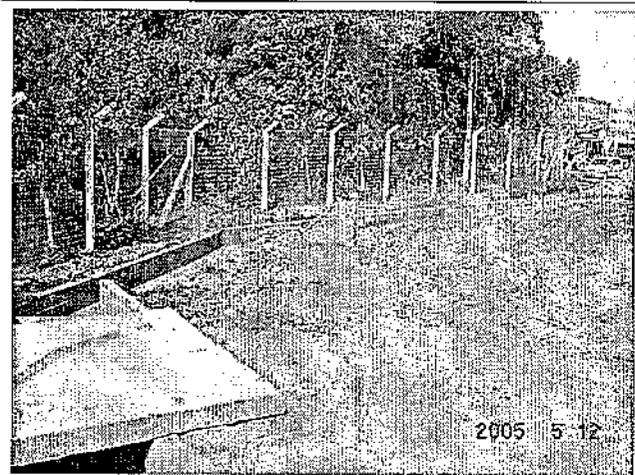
Canteiro de obras da Queiroz Galvão com sistema de drenagem implantado após solicitação.
